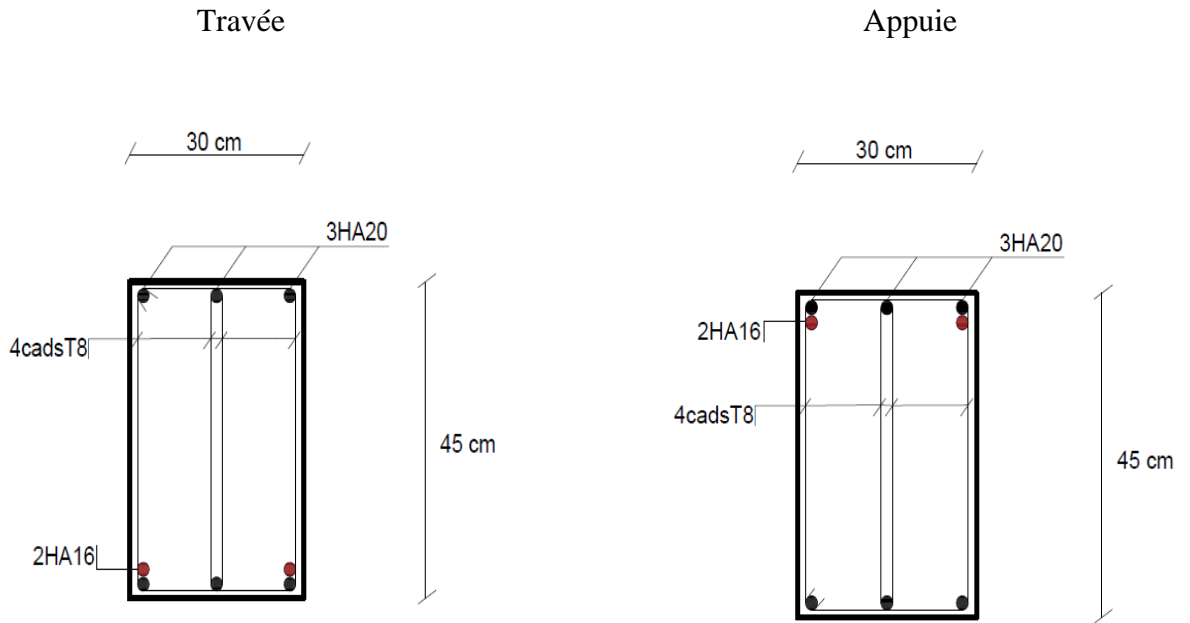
Schéma de ferrailage des poutres (45x30).
